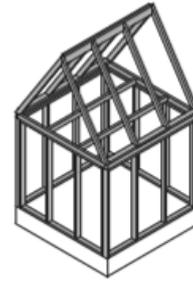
Entramados pesados: detalle elementos cubierta inclinada de madera
